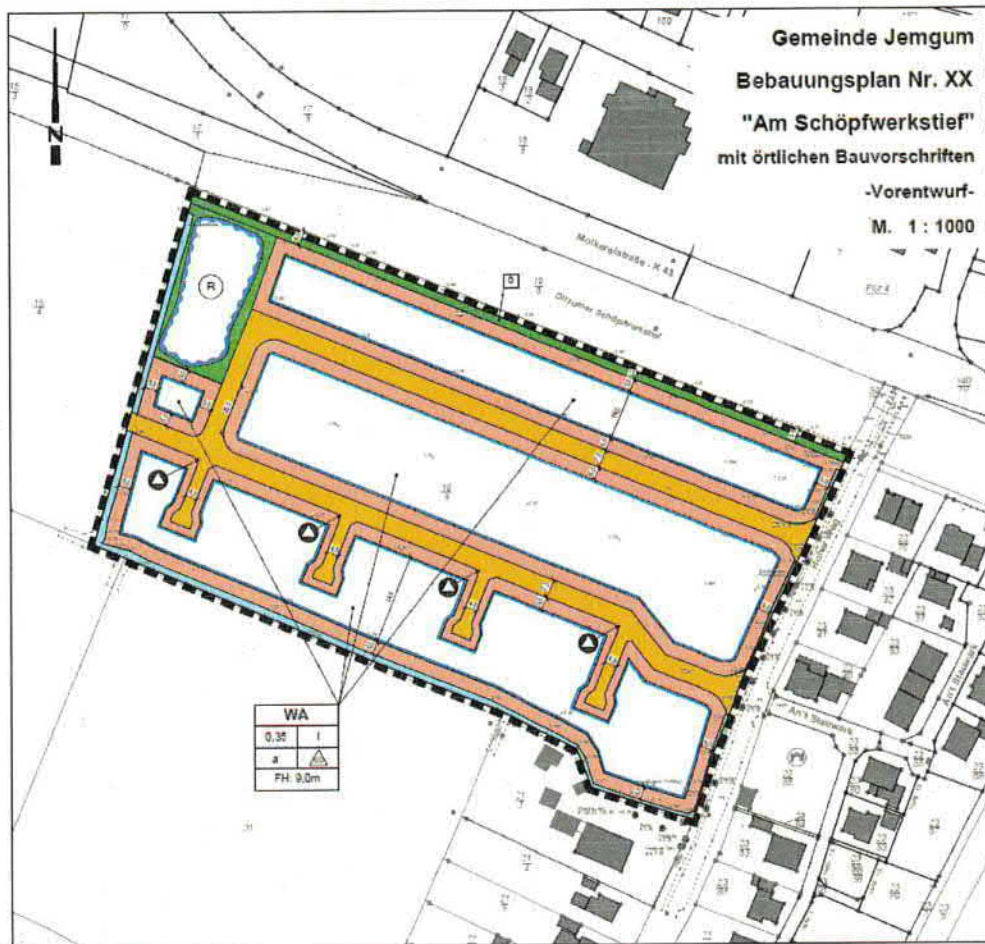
B-Plan Nr.0306 Planzeichnung VE vom 8.10.2021
